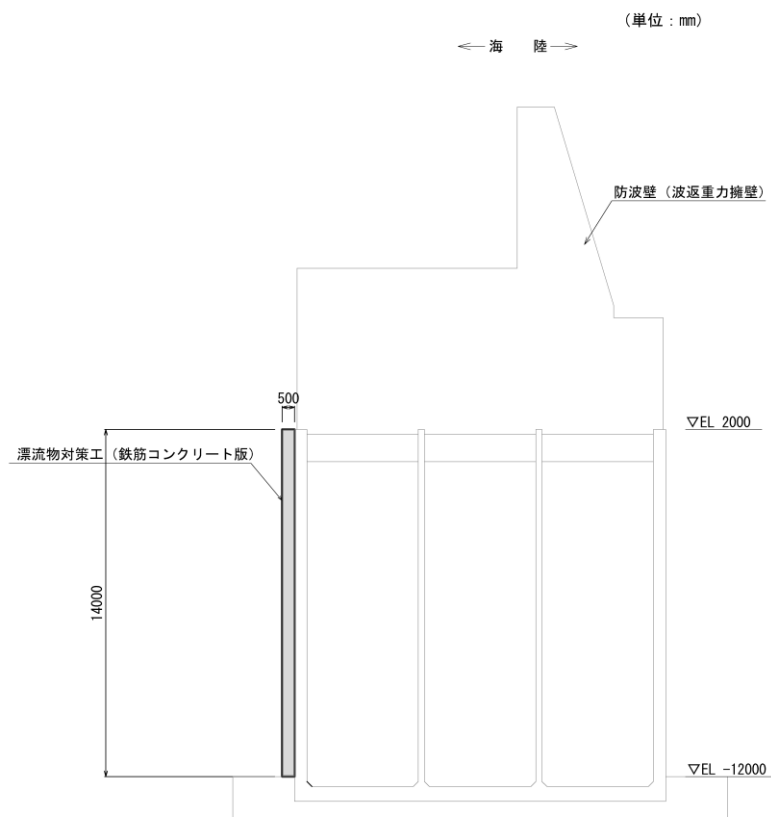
(4) 防波壁 (波返重力擁壁) ケーソンにおける漂流物対策工 (鉄筋コンクリート版) の構造概要図 (標準断面図)
